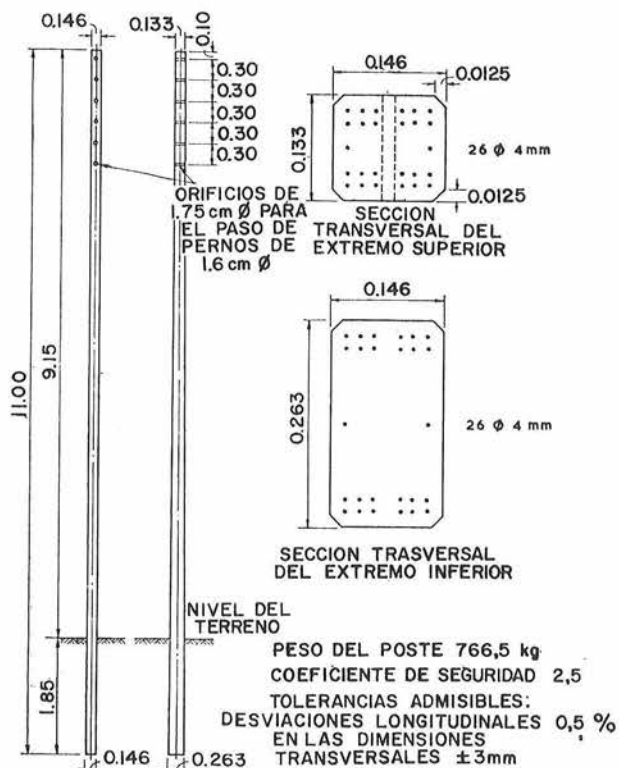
Detalle de uno de los postes de hormigón pretensado, de sección transversal rectangular, tipo 36/400.
